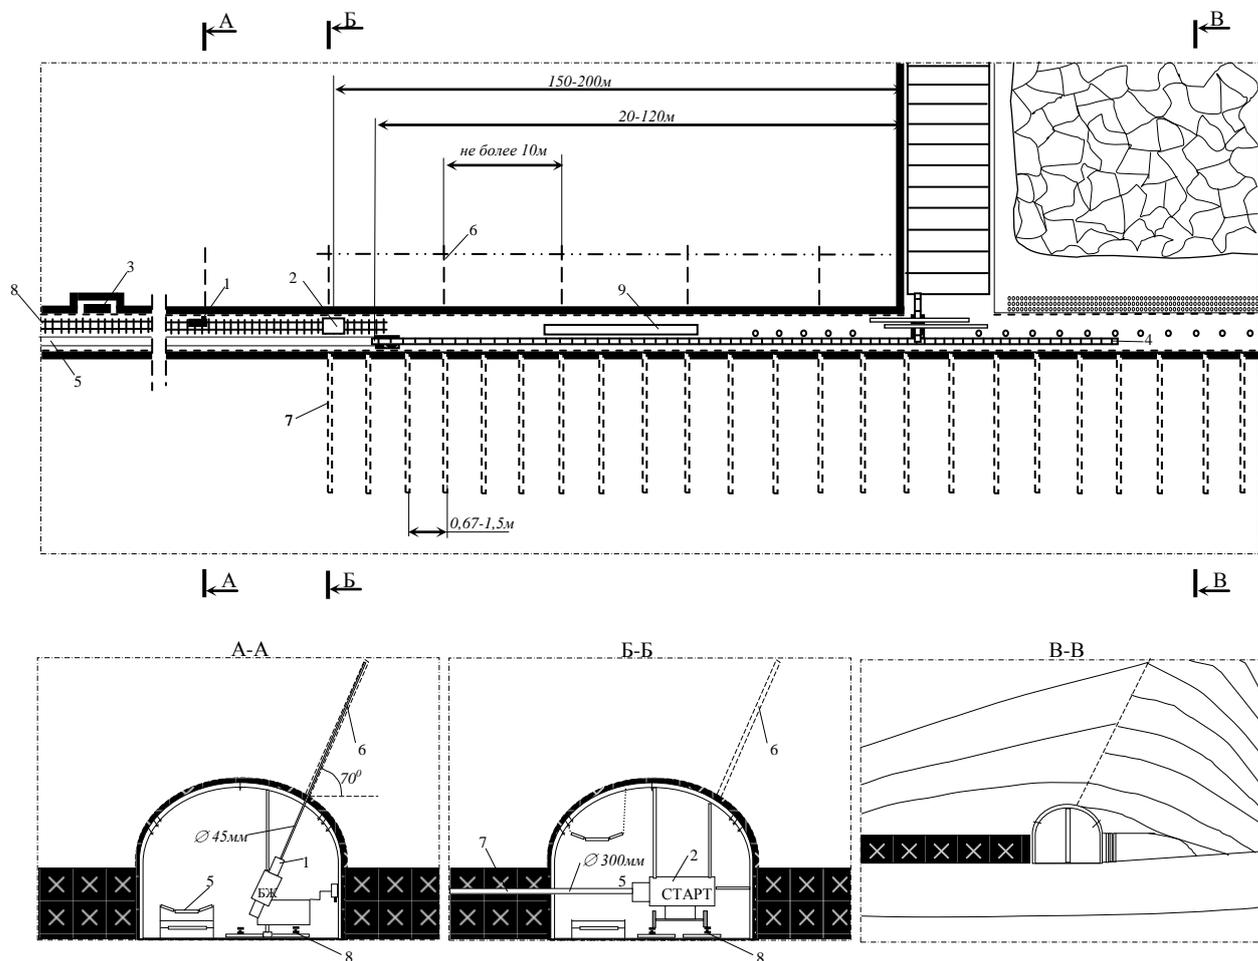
Схема расположения оборудования при выполнении комплексного способа охраны выработок: 1-станок БЖ45-100; 2-буровая установка «Старт»; 3-насос 2УГН; 4-скребковый конвейер; 5-верхняя лента ленточного конвейера; 6-отрезная скважина диаметром 300 мм; 7-скважина диаметром 45 мм; 8-рельсовый путь.
